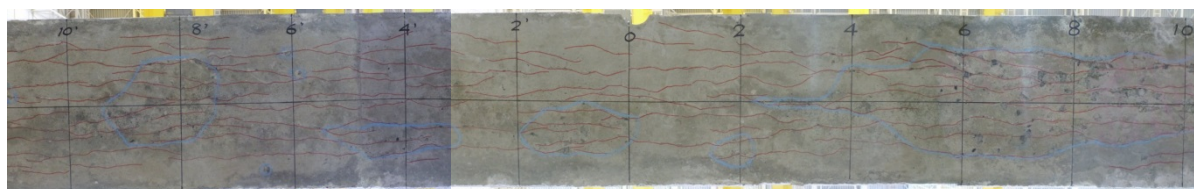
G3 桁桁下面ひび割れ状況 (桁中央から前後 1m の範囲)
